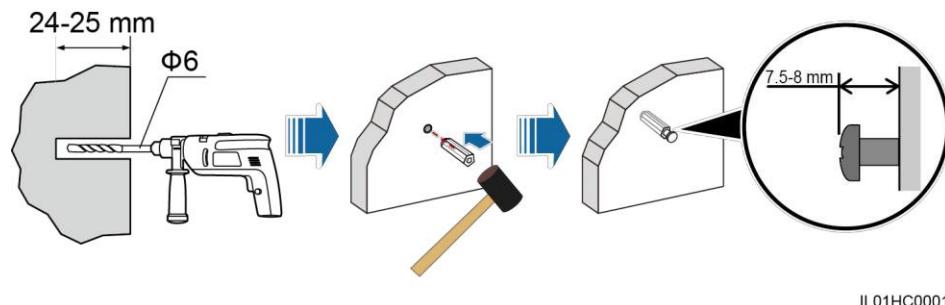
Сверление отверстия и установка дюбелей и винтов.
